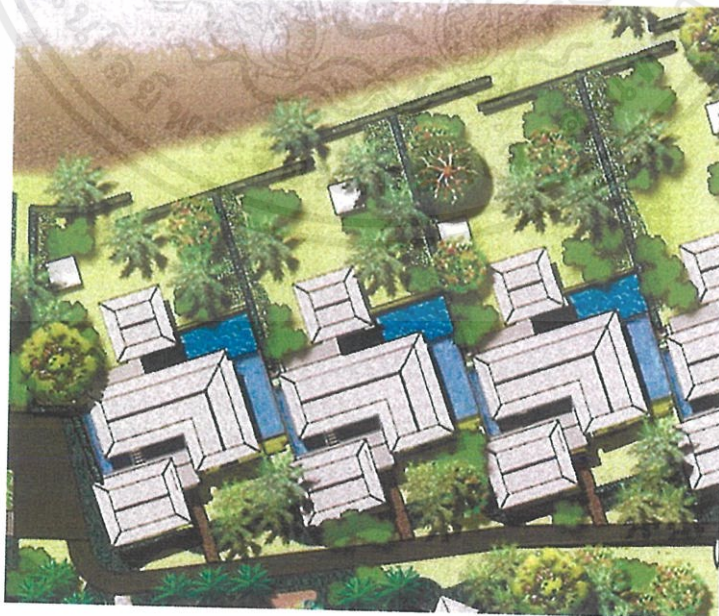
WET PLAYGROUND PLAN
